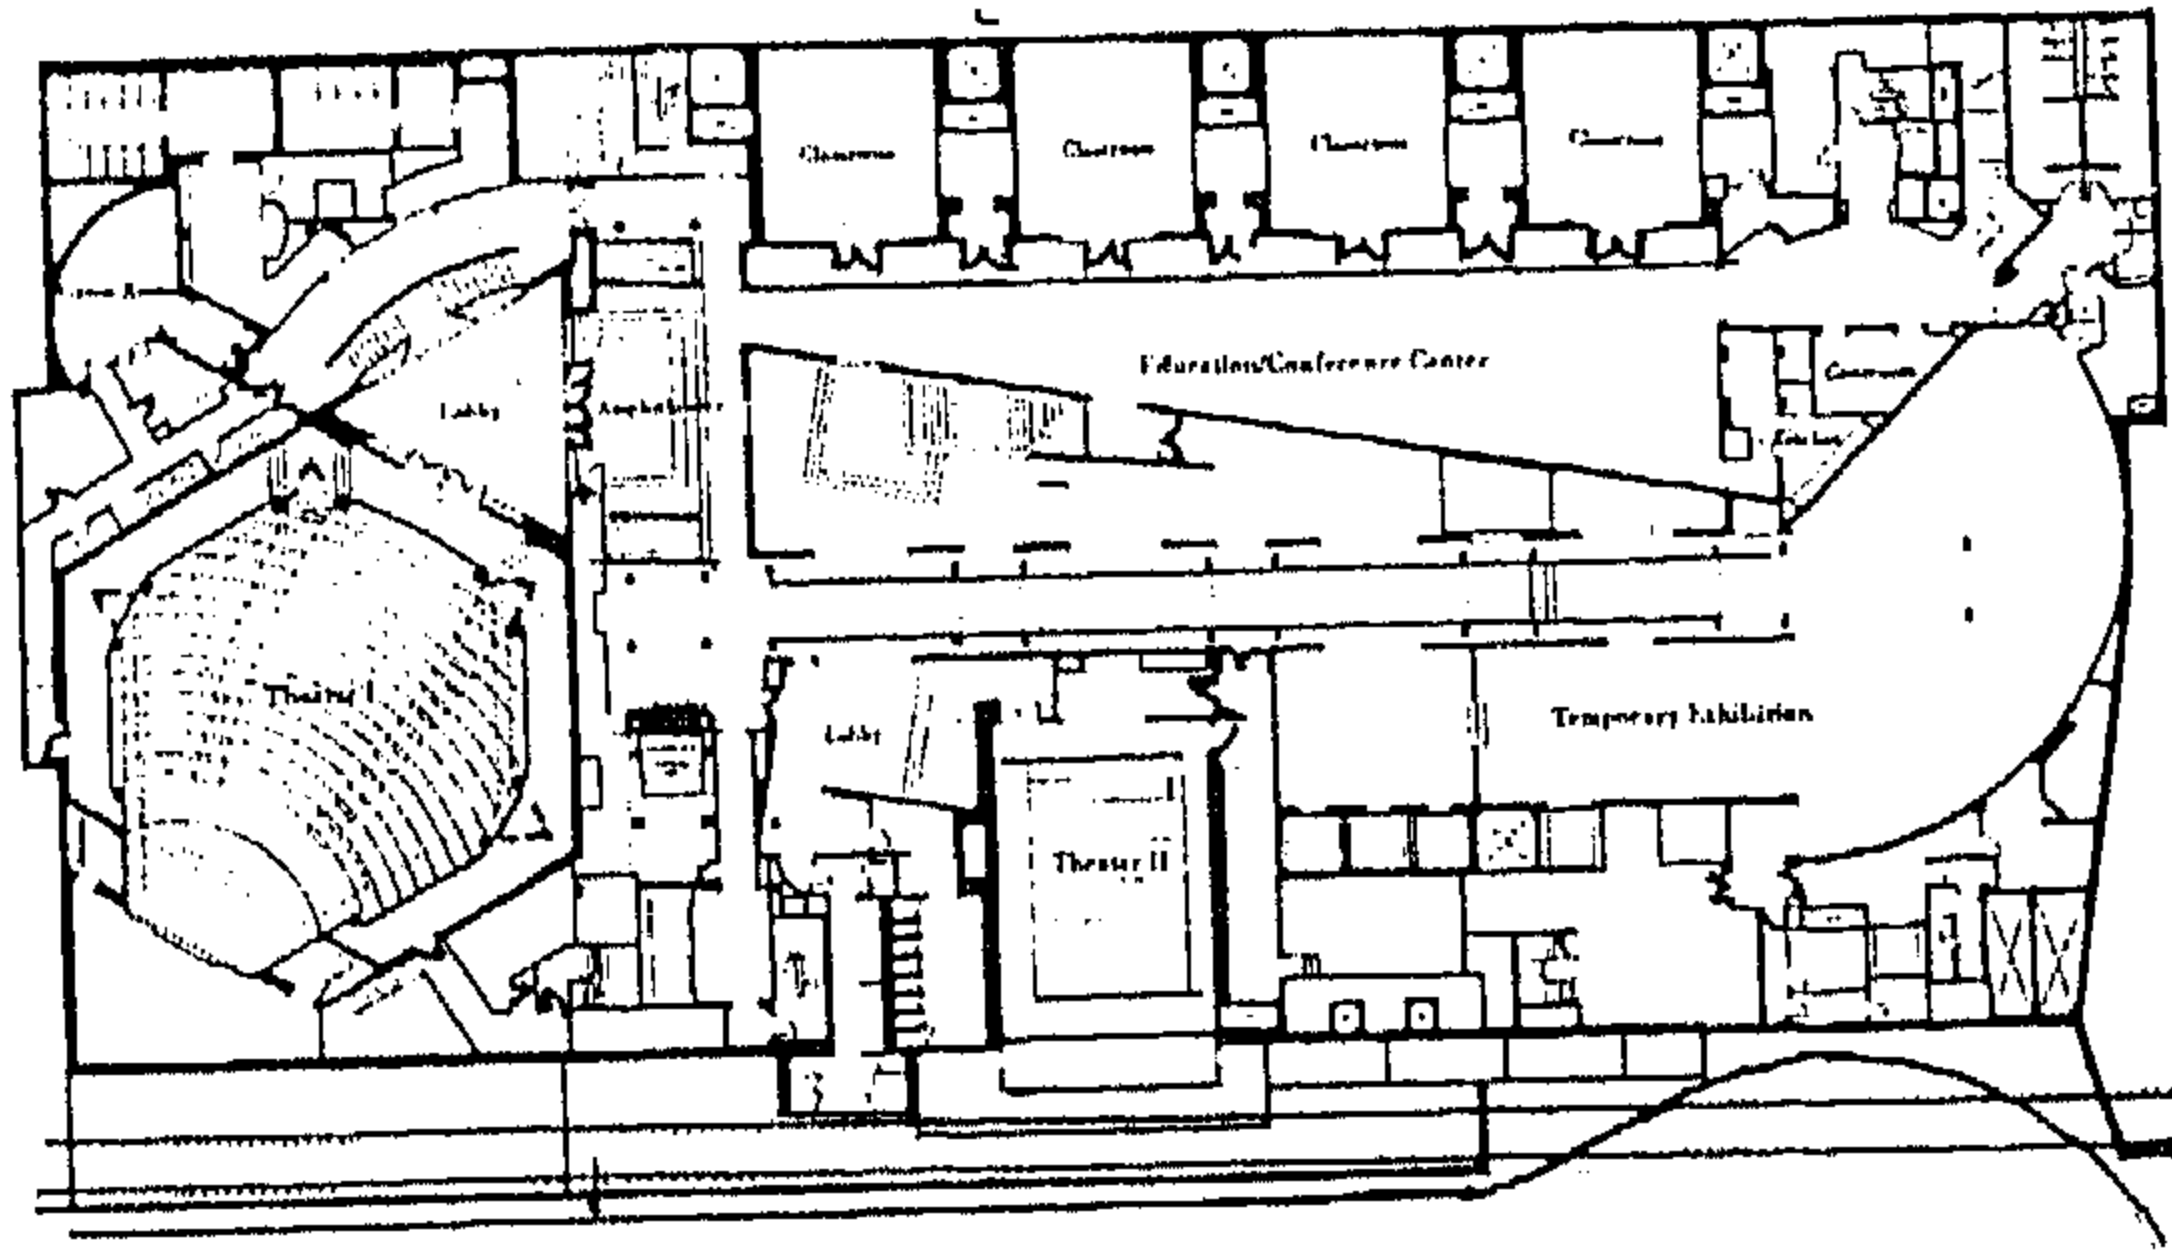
مسقط أفقي للطابق الأرضي
